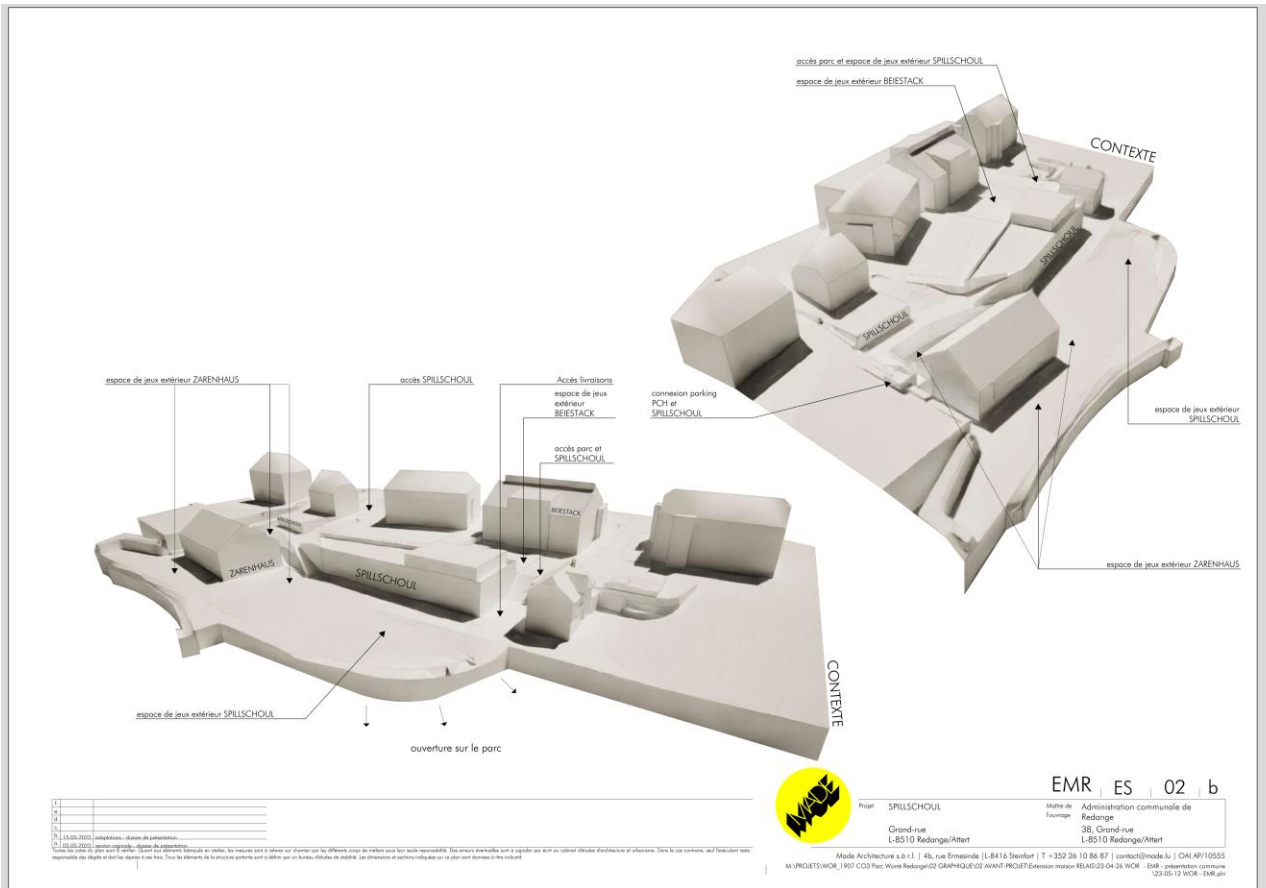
geplante Stellung der „Spillschoul“ innerhalb der bestehenden Gebäude. Quelle: Made Architecture 2023
